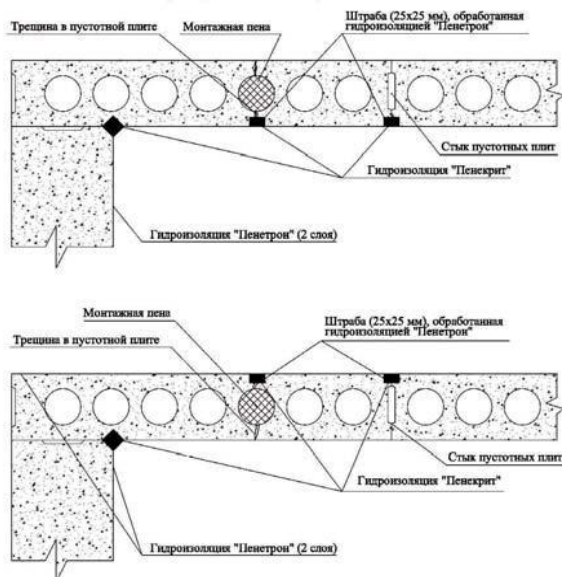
Устройство гидроизоляции в сборных пустотных плитах перекрытия
